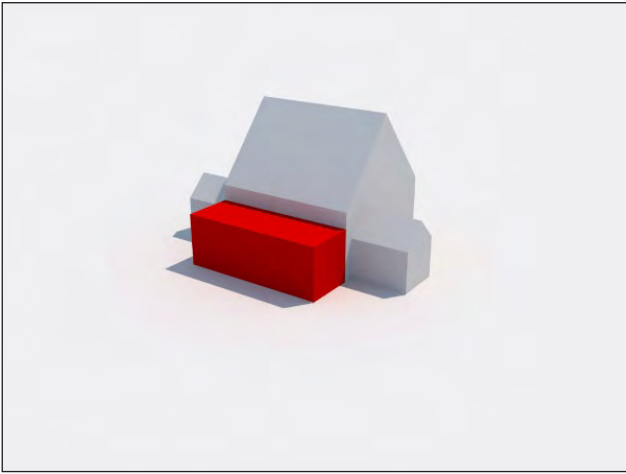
3D-Ansichten der möglichen rückwärtigen Anbauten zum Haustyp A (Doppelhaus mit seitlichem Stallanbau)
